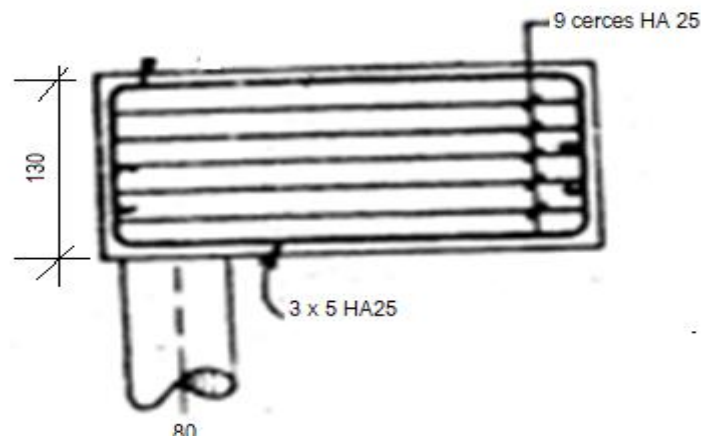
Coupe longitudinale du schéma de ferrailage de la semelle sur 3 pieux
